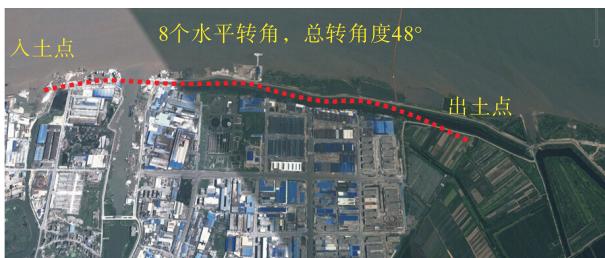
陆管36-1管道瓯江路定向钻双曲线施工示意图
